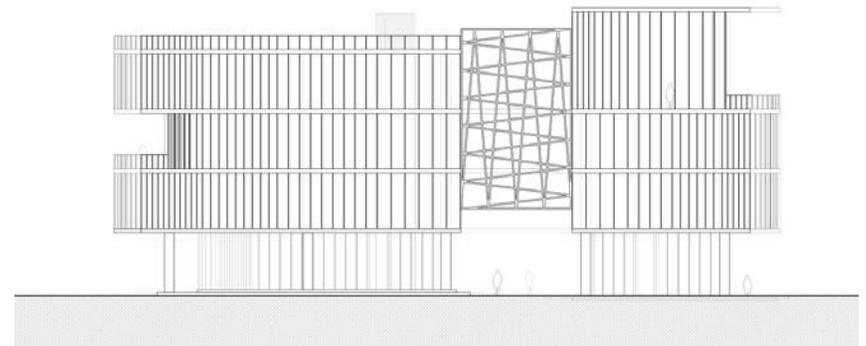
Elevación Sur (Alameda). 25 de Agosto del 2018. Elab. Propia.
